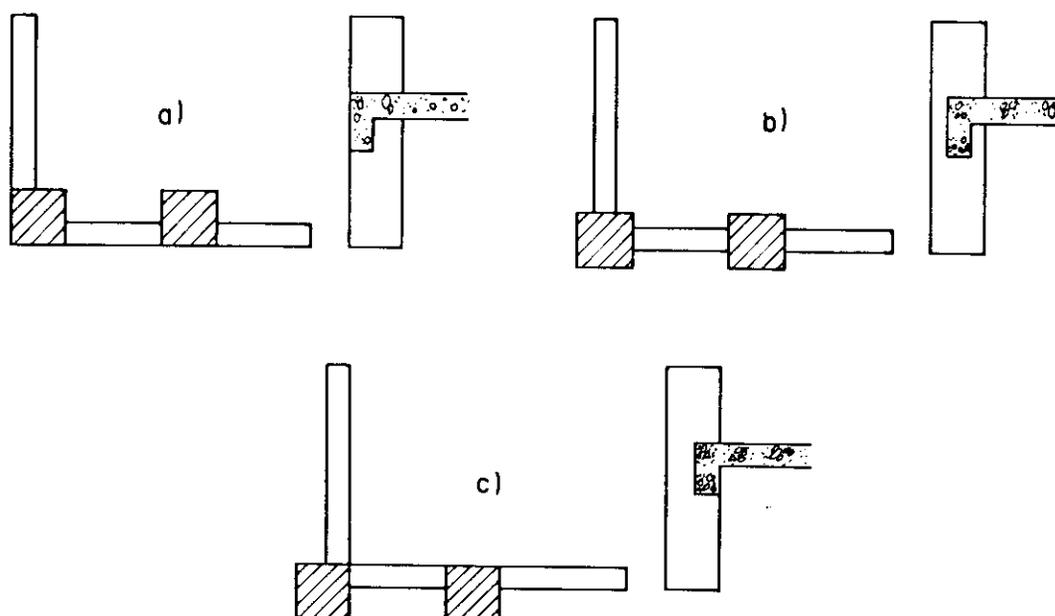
Posicionamento Dos Pilares Internos à Construção
